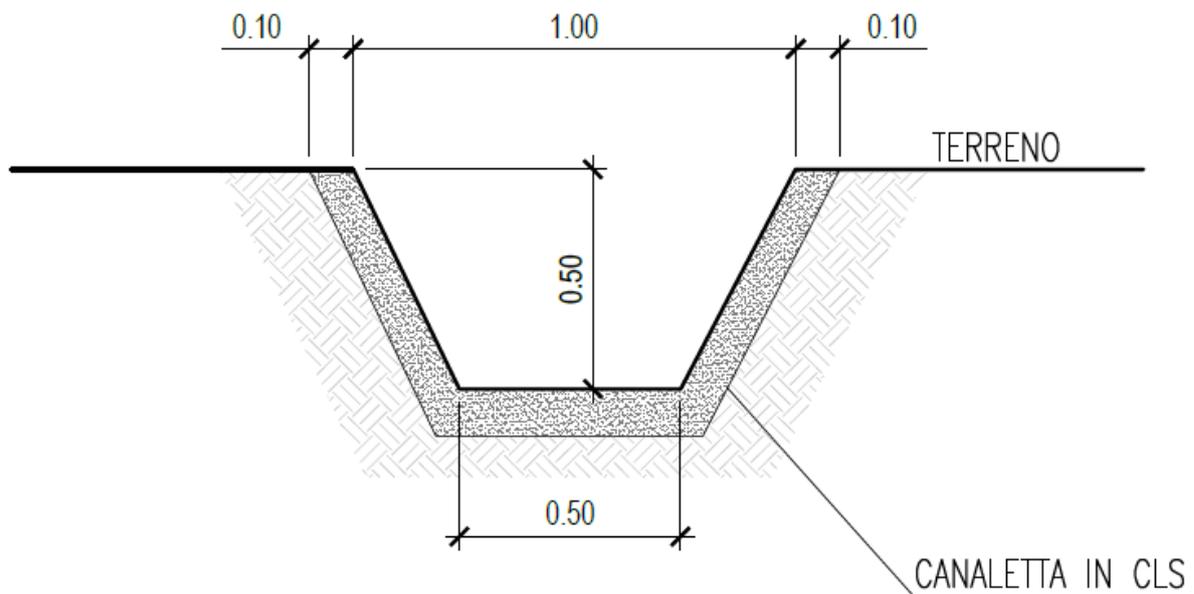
Tipologia di sezioni trapezie in calcestruzzo utilizzate
